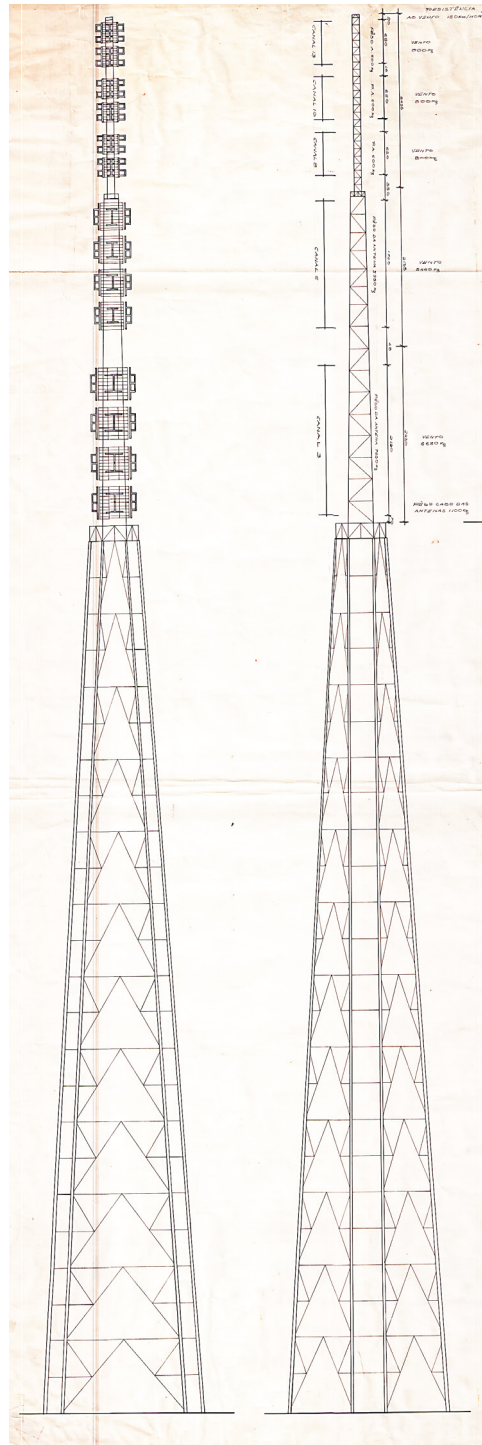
Detalhamento da estrutura metálica da Torre. Fonte: ARPDP.
